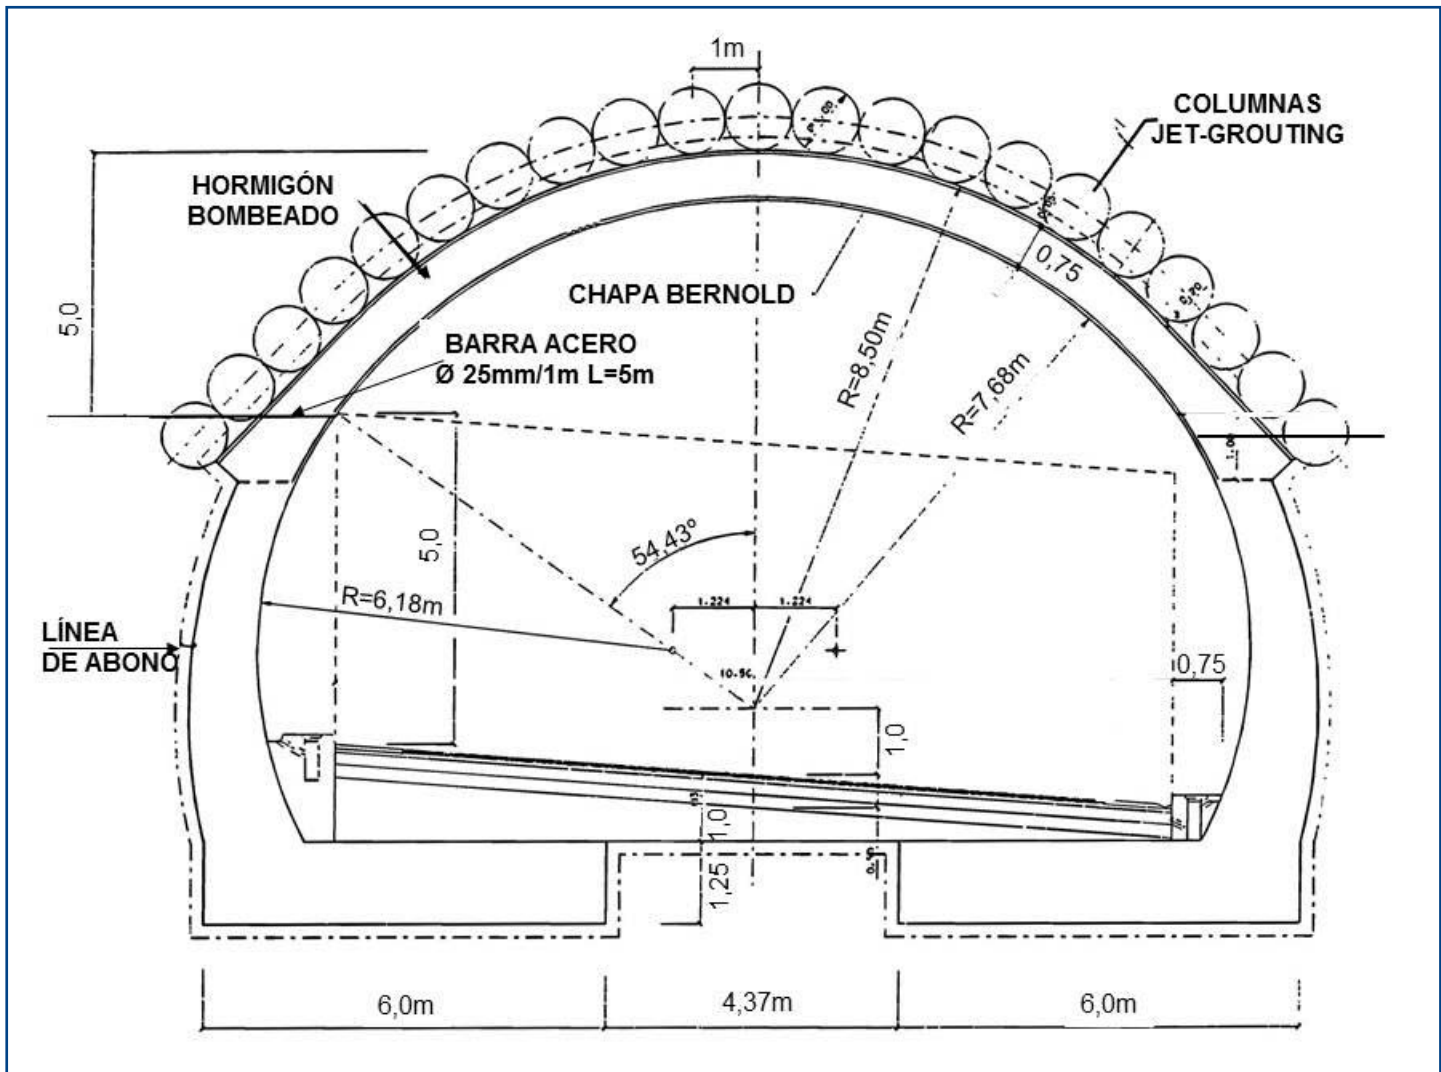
Sección del túnel, incluyendo posible prebóveda con columnas de jet-grouting. (Sustituido por enfilajes de micropilotes metálicos).
